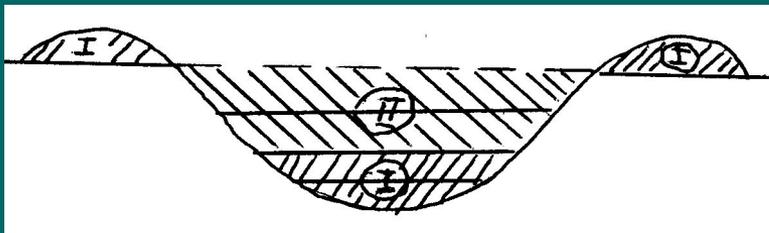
Схема засыпки воронки из резерва экскаватором “обратная лопата”.
